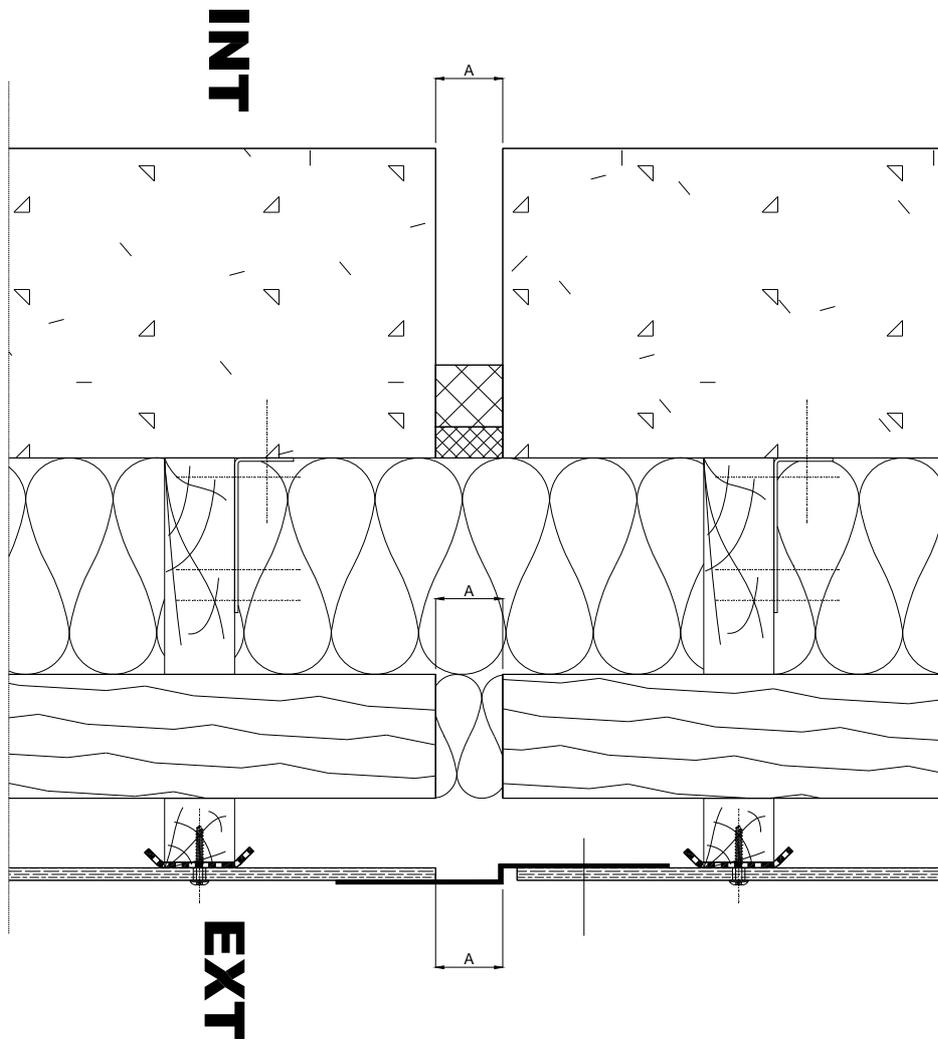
Coupe horizontale – Joint de dilatation du béton compris entre 12 et 15 cm
